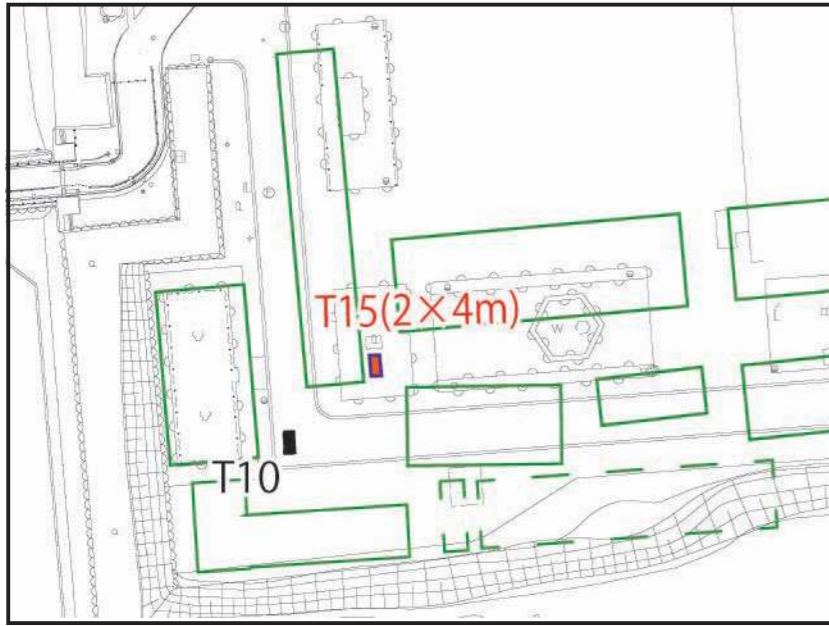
博物館 明治村所蔵「歩兵第六連隊平面図集 平面図」拡大図
